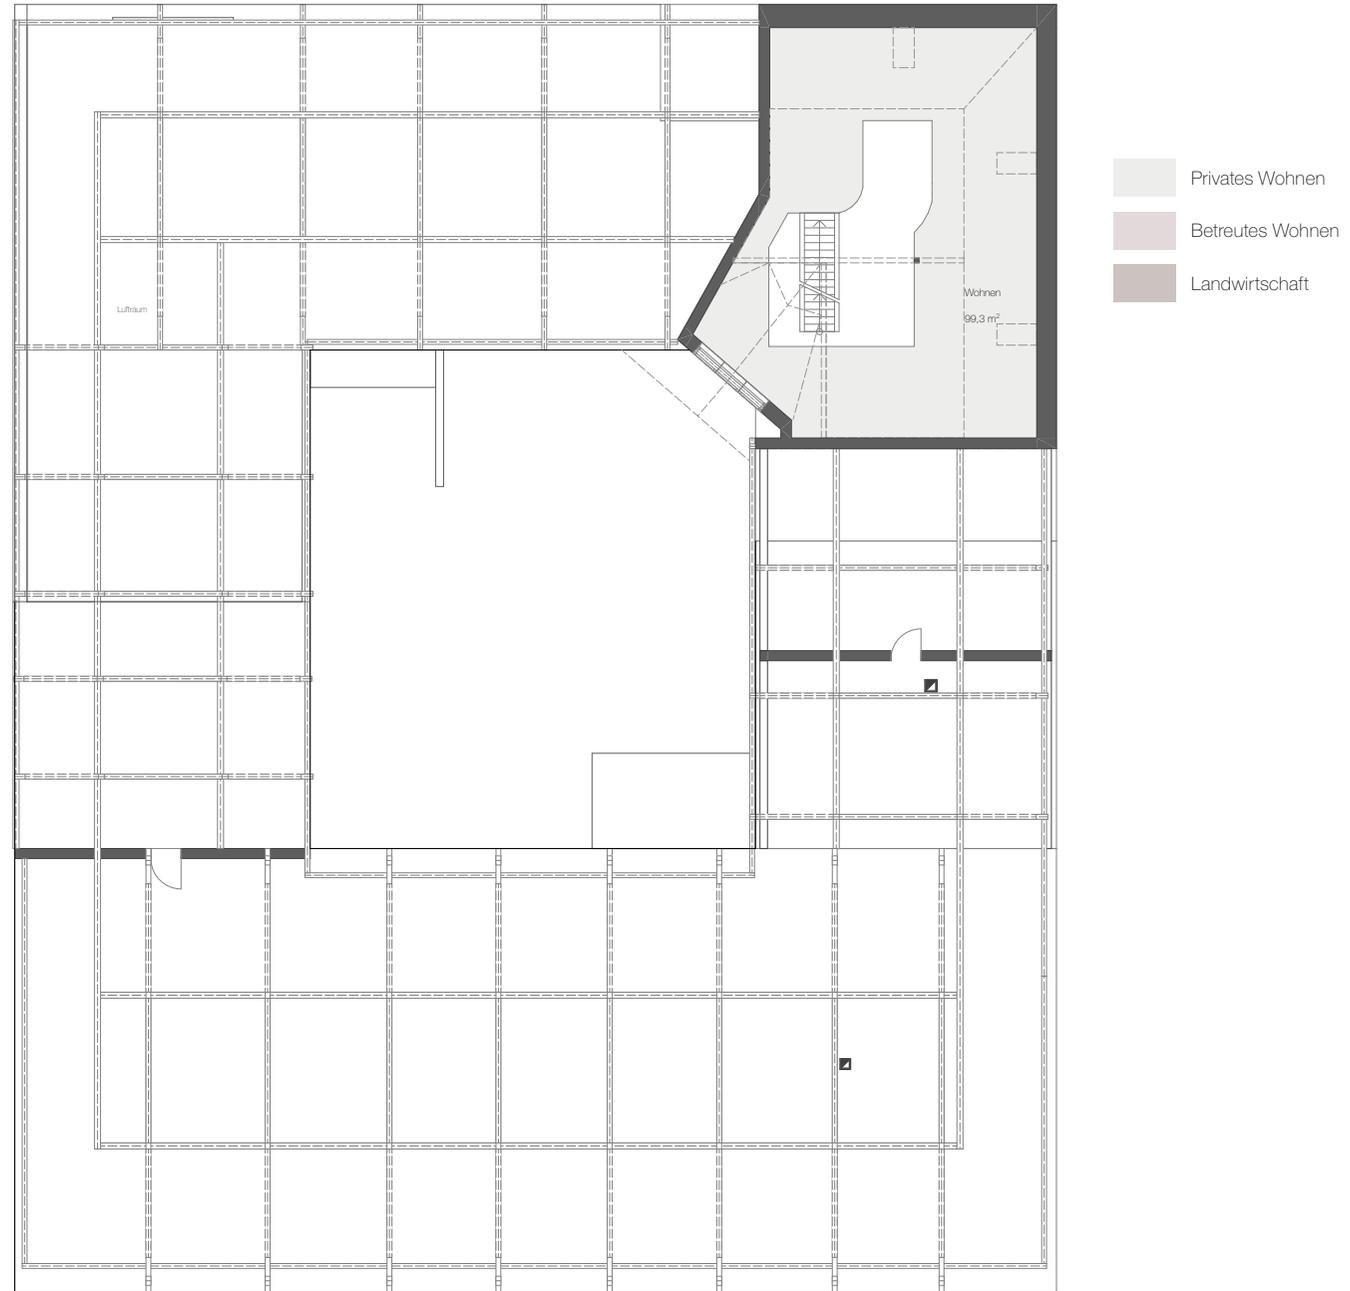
| Grundriss Dachgeschoss
